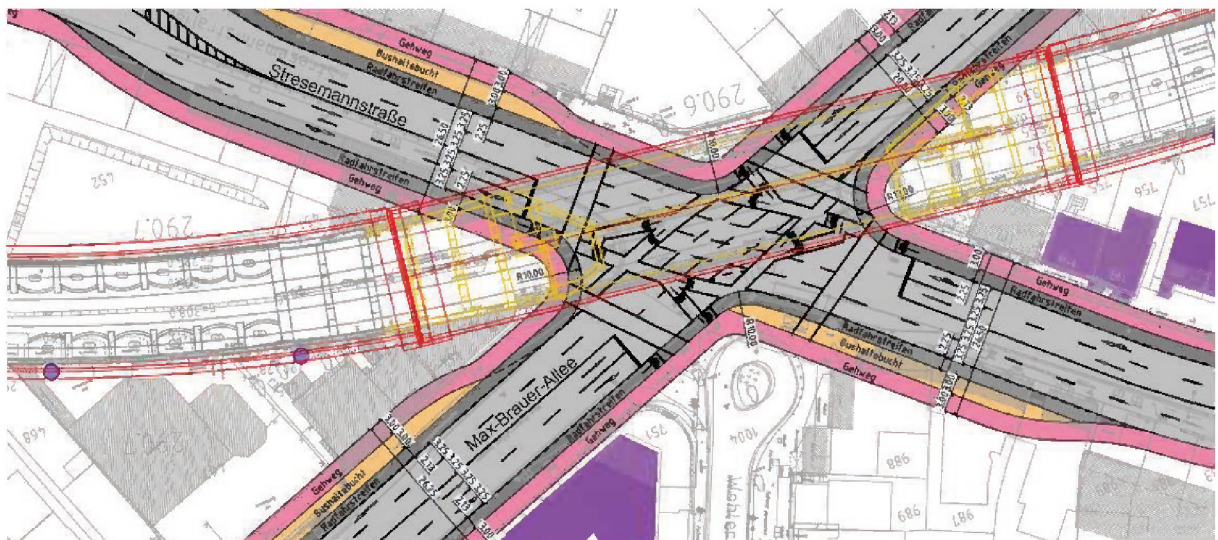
Kreuzungsausführung Vorzugsvariante DB, Quelle: [1] Anlage 9.2 - Plan VP_V_A09.2_LPL_001
